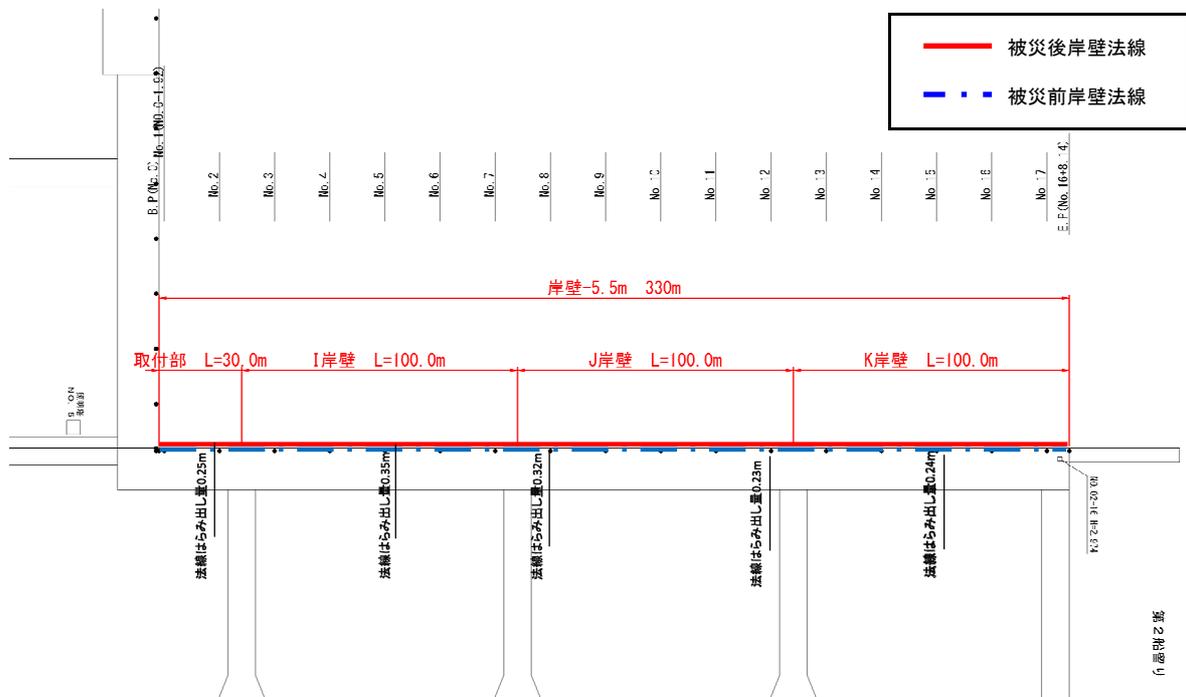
No.18 常陸那珂港区_北ふ頭地区岸壁 (-5.5m) I,J,Kの平面図 (被災後)
